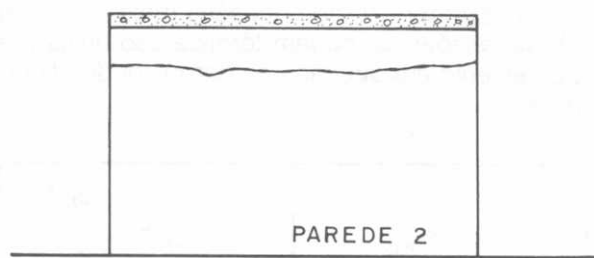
Trinca típica presente no topo da parede paralela à largura da laje.
